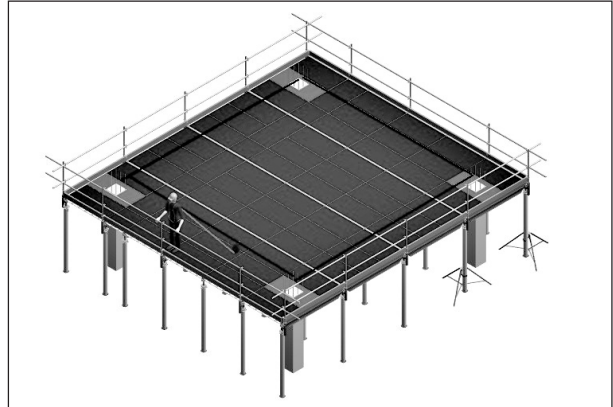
Colocación de pies de barandilla, tubos de las barandillas superior e intermedia y rodapiés
